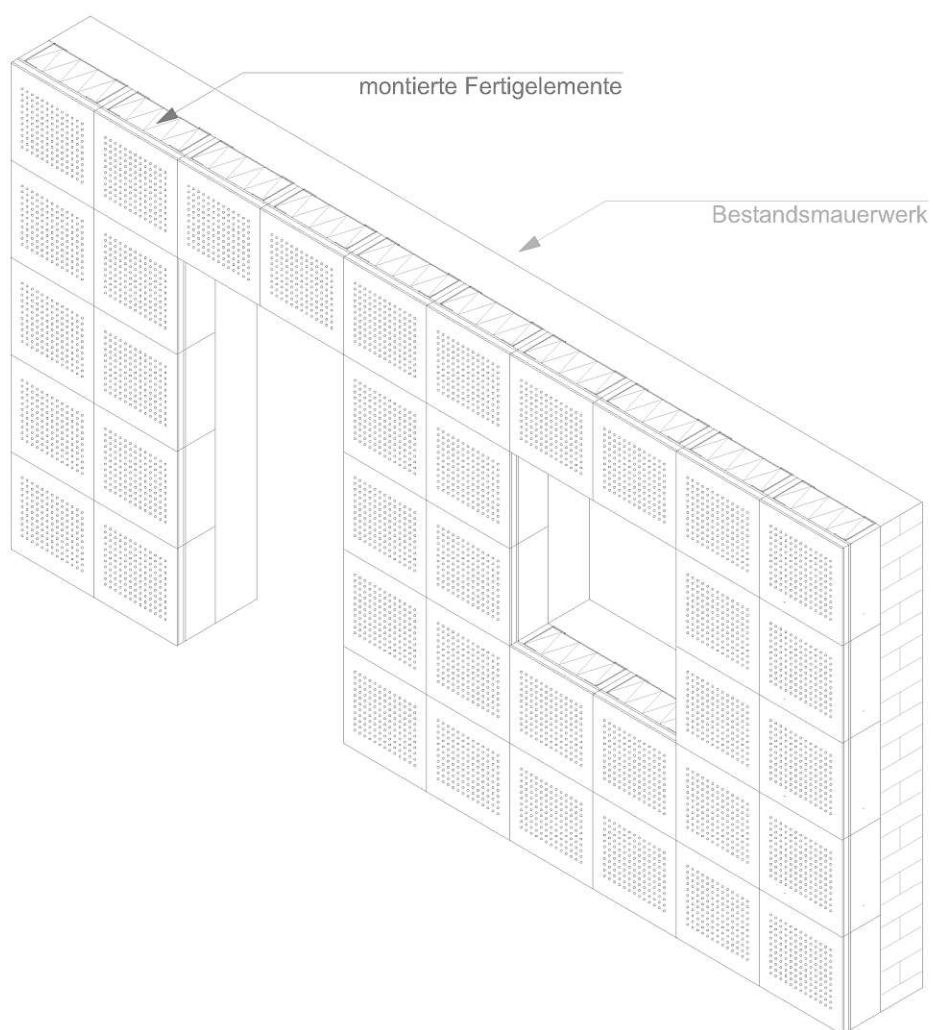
Beispielhafte Anwendung des Grundmoduls (erste Schale) an einer Fassade
